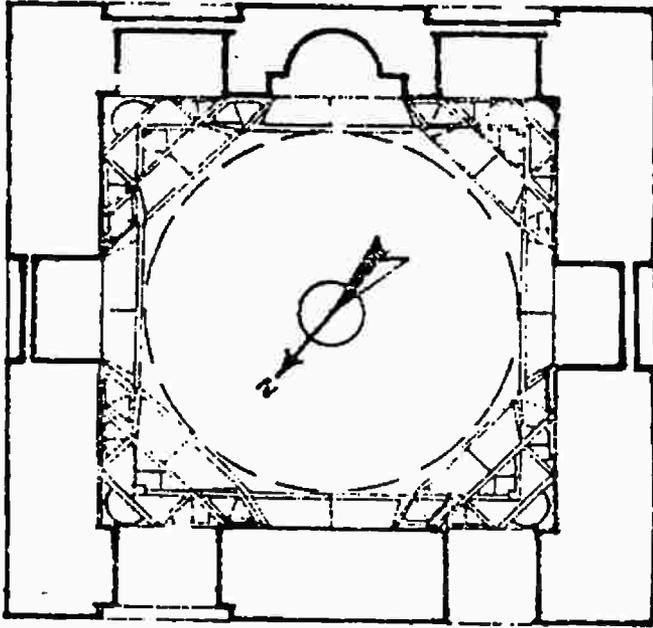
مسقط أفقي مقترح لخانقاة قوصون بقرافة الميوطي.
